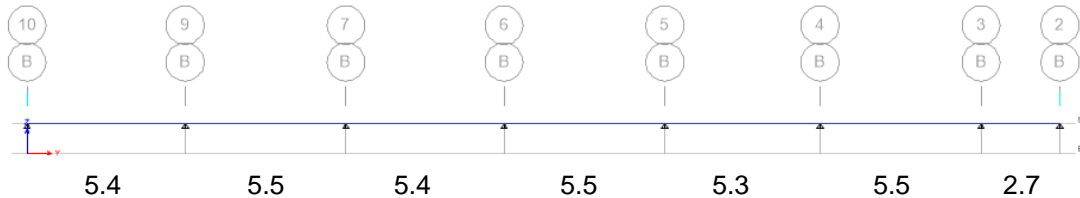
Idealización de losa aligerada armada en el eje transversal Y
